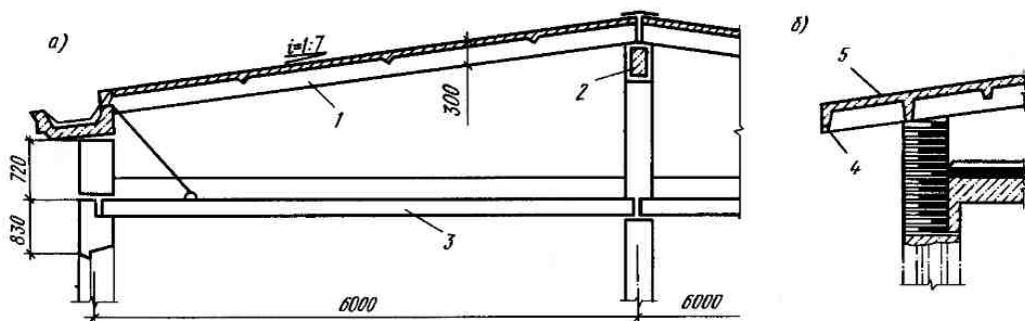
Сборная железобетонная крыша из ребристых панелей:
